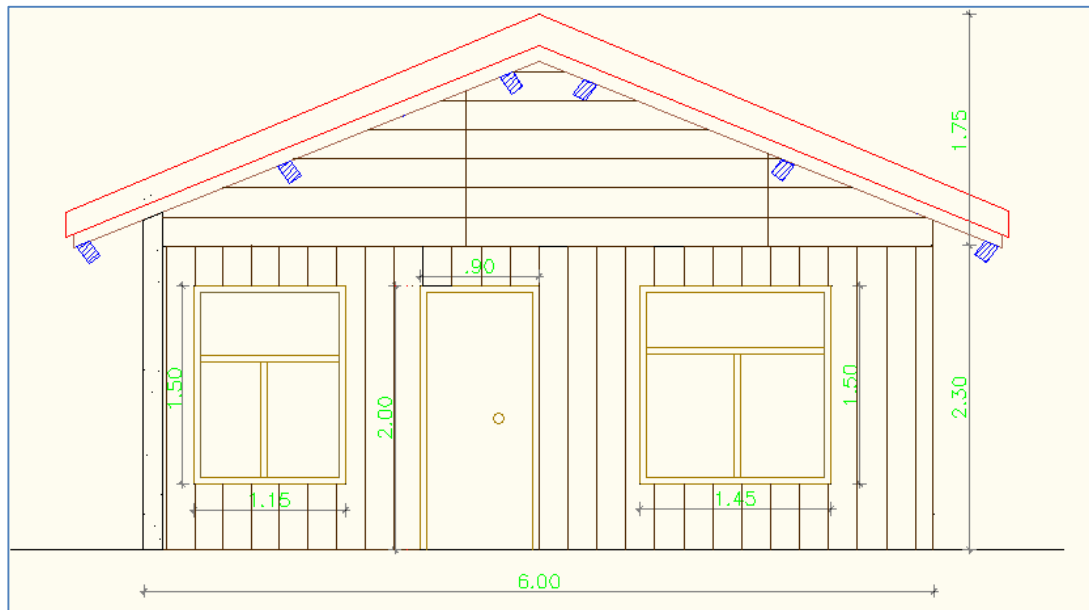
FACHADA PRINCIPAL VIVIENDA EN MADERA
